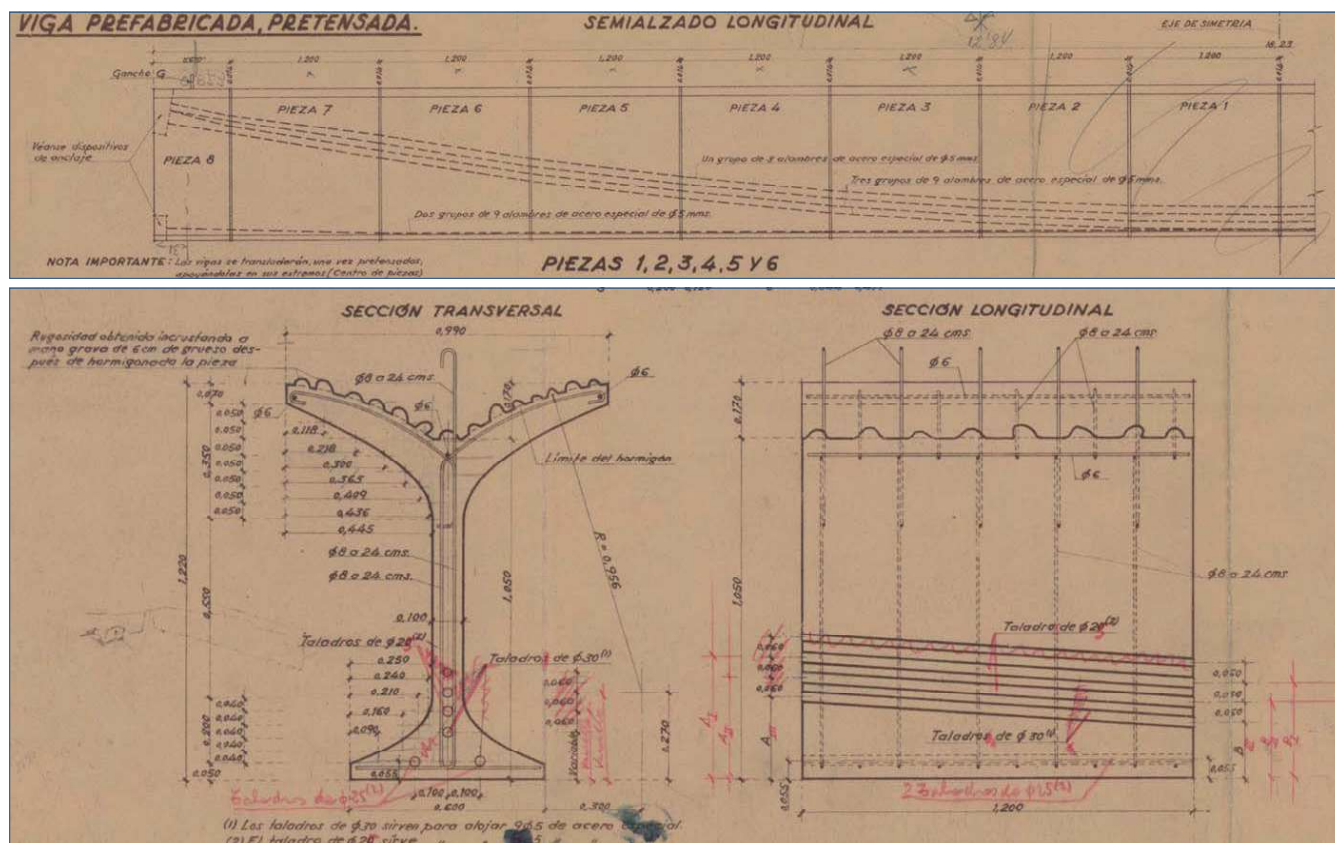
Configuración del pretensado longitudinal y detalle de la sección transversal de las vigas
